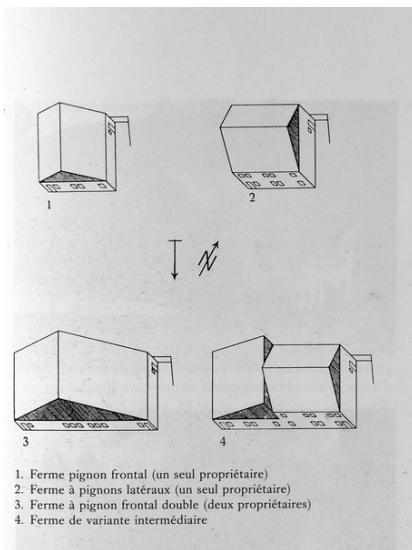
Schéma d'agrandissement des fermes à pignon frontal par retournement de la toiture et l'adjonction d'un niveau.
